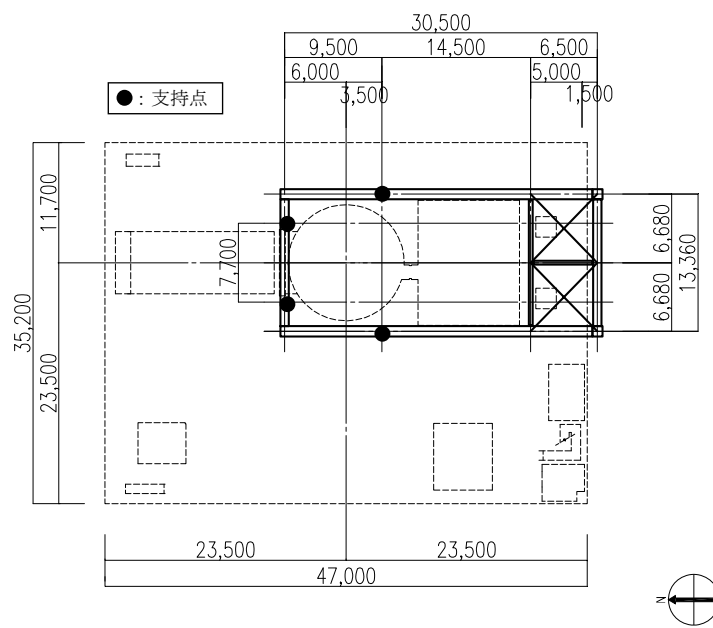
燃料取扱機支持用架構 梁伏図 (O. P. 41, 420)
